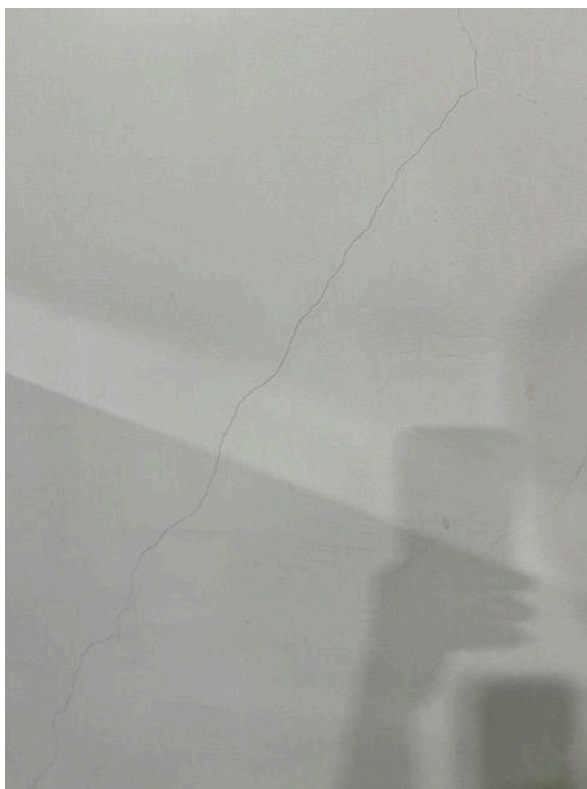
Marcação 1.3 e 2.2 - Infiltração e fissuras na parede da biblioteca.
